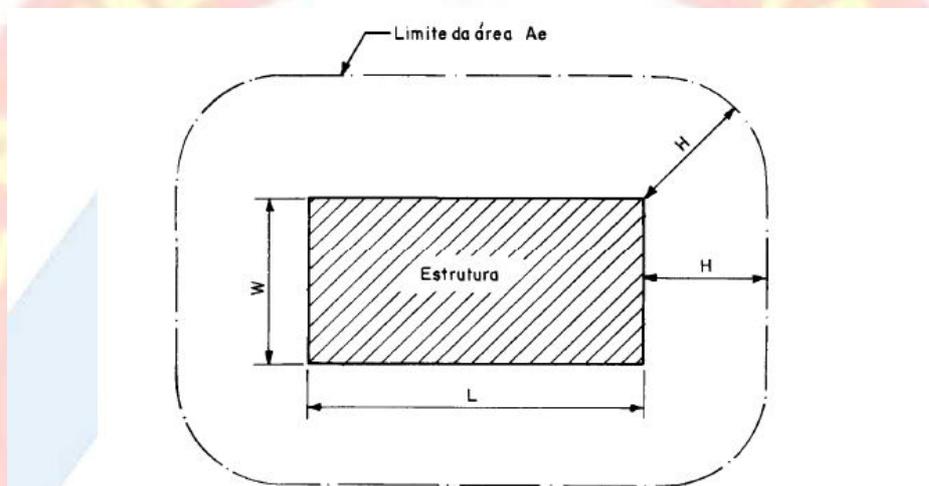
Delimitação da área de exposição equivalente (Ae) - Estrutura vista de planta
